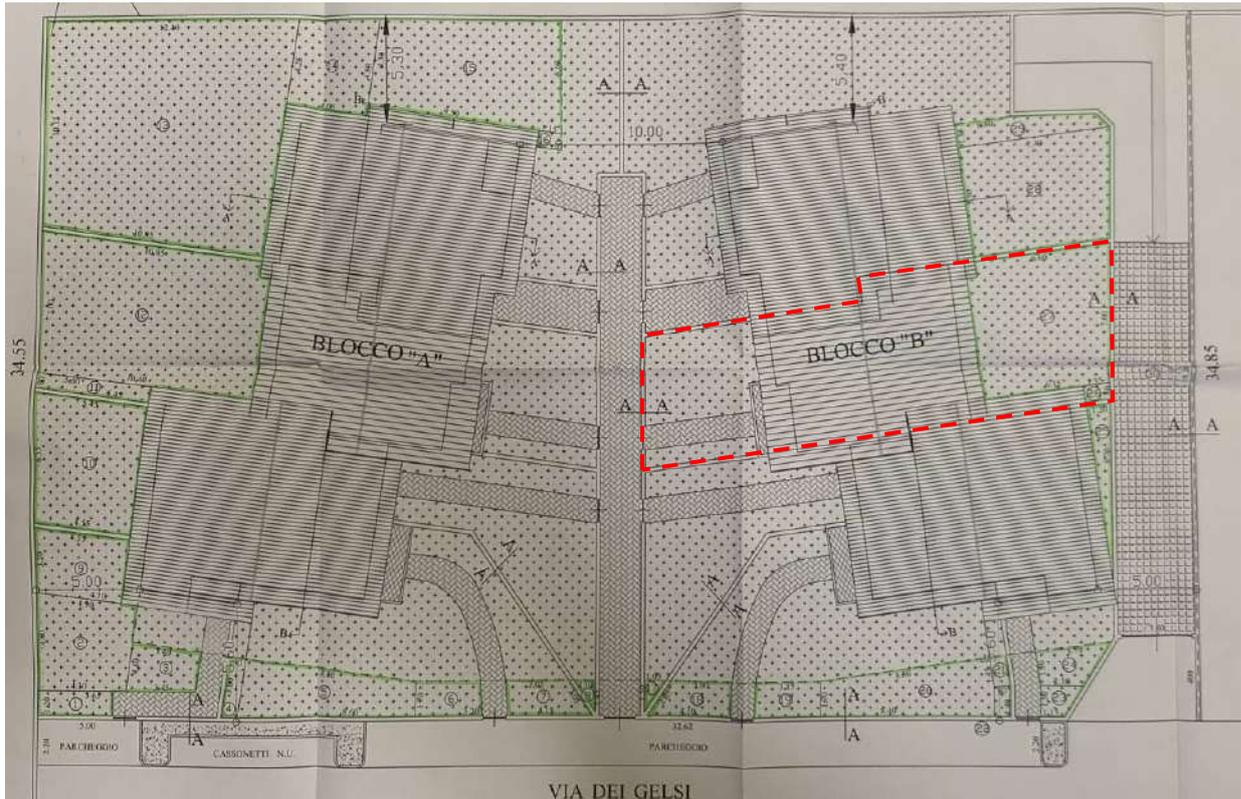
D.I.A. n. 05 Prot. 1315 del 09.02.2005 – Estratto tav. 1 planimetria di progetto con indicazione dell'immobile in oggetto
